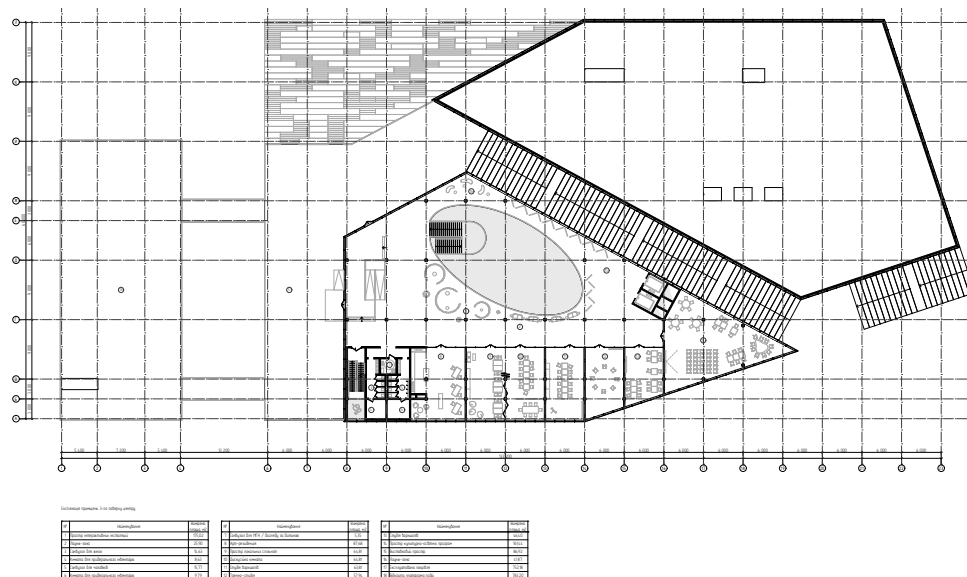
План 3-го поверху на відм. +9,000
